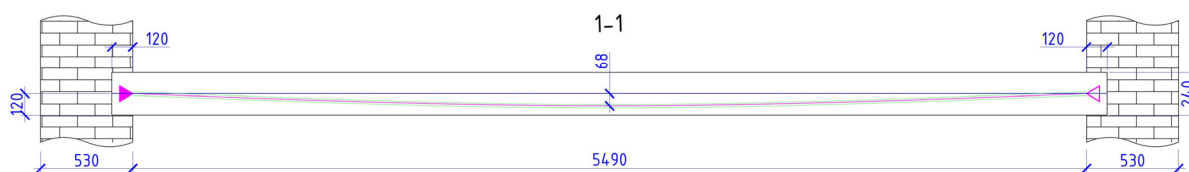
Разрез 2-го варианта перекрытия вдоль монострендов
